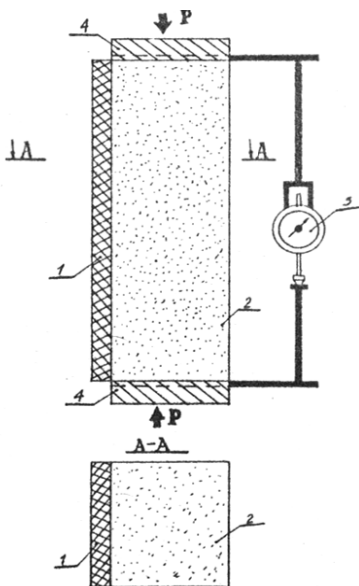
Схема испытания для определения степени сцепления отделочного покрытия с бетоном:
